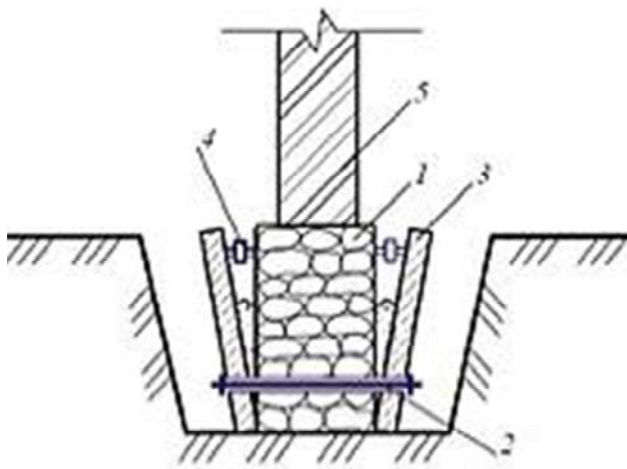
Увеличение площади подошвы фундамента с помощью железобетонных отливов:
